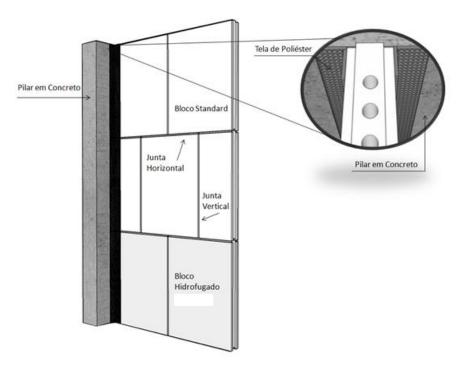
Detalhe do encontro entre a vedação em bloco de gesso e pilar.
